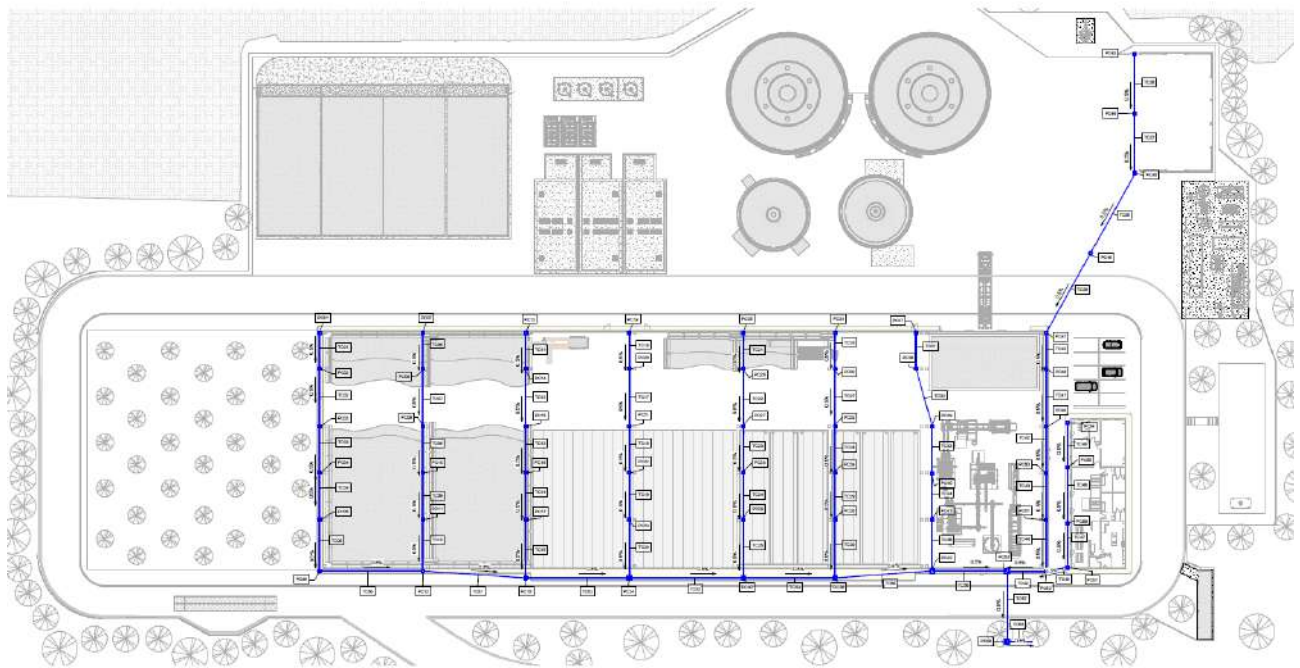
ESE.EGR.MET.006 – Planimetria generale acque meteoriche dalle coperture
